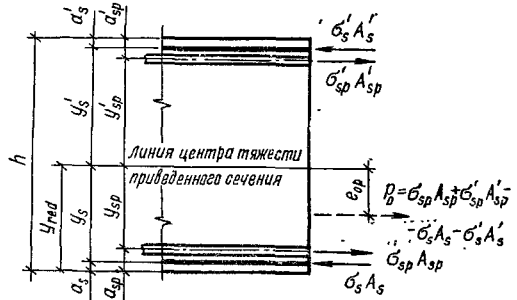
Схема усилий предварительного напряжения арматуры в поперечном сечении железобетонного элемента.
